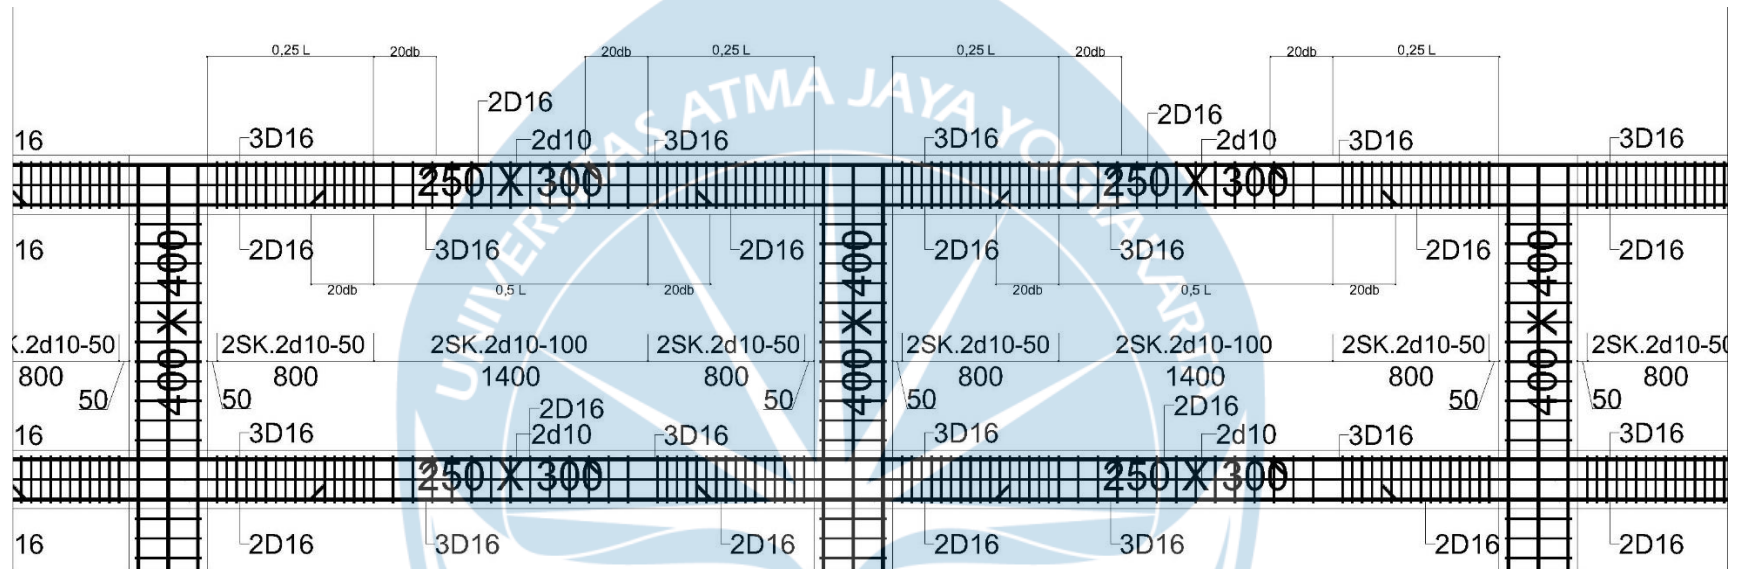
Detail penulangan kolom-balok dag as A dan B
